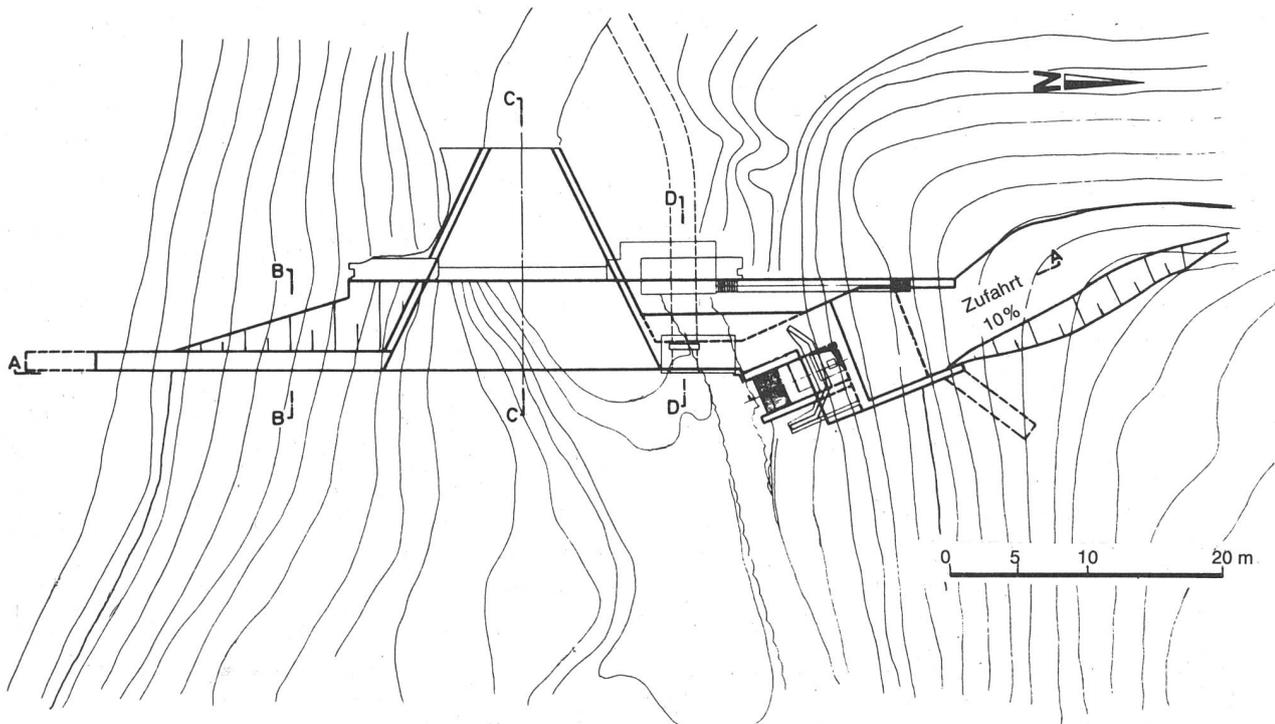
Grundriss und Schnitte der Staumauererhöhung im Ausgleichsbecken Käppelistutz.
